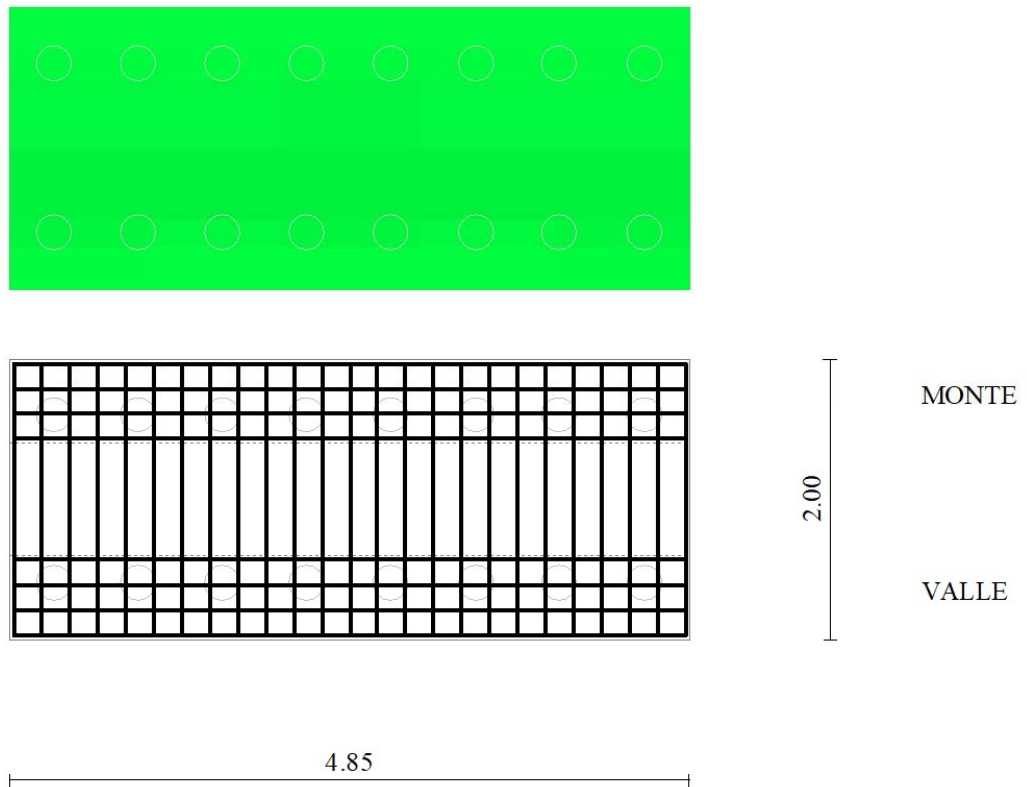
Piastra fondazione dir. Y (Inviluppo)
